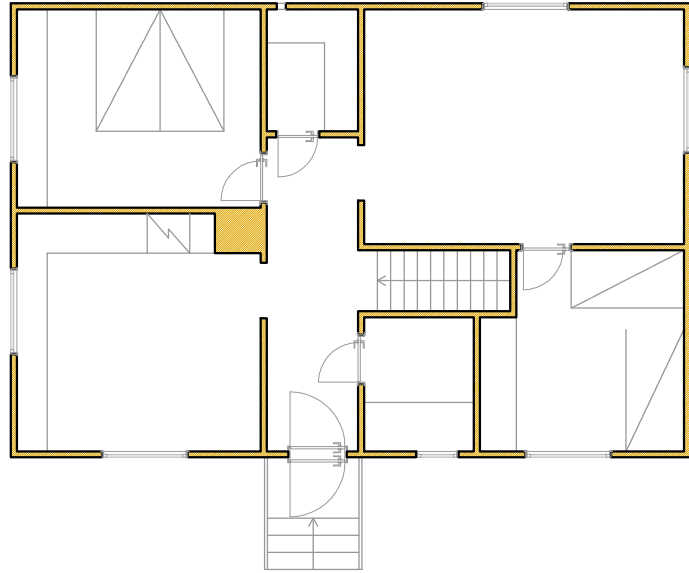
Reconstrucción de la planta tipo de una *egnahem*. E 1:125
